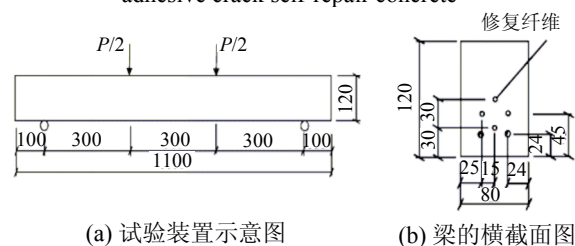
内置纤维胶液管钢筋混凝土裂缝自修复试验
